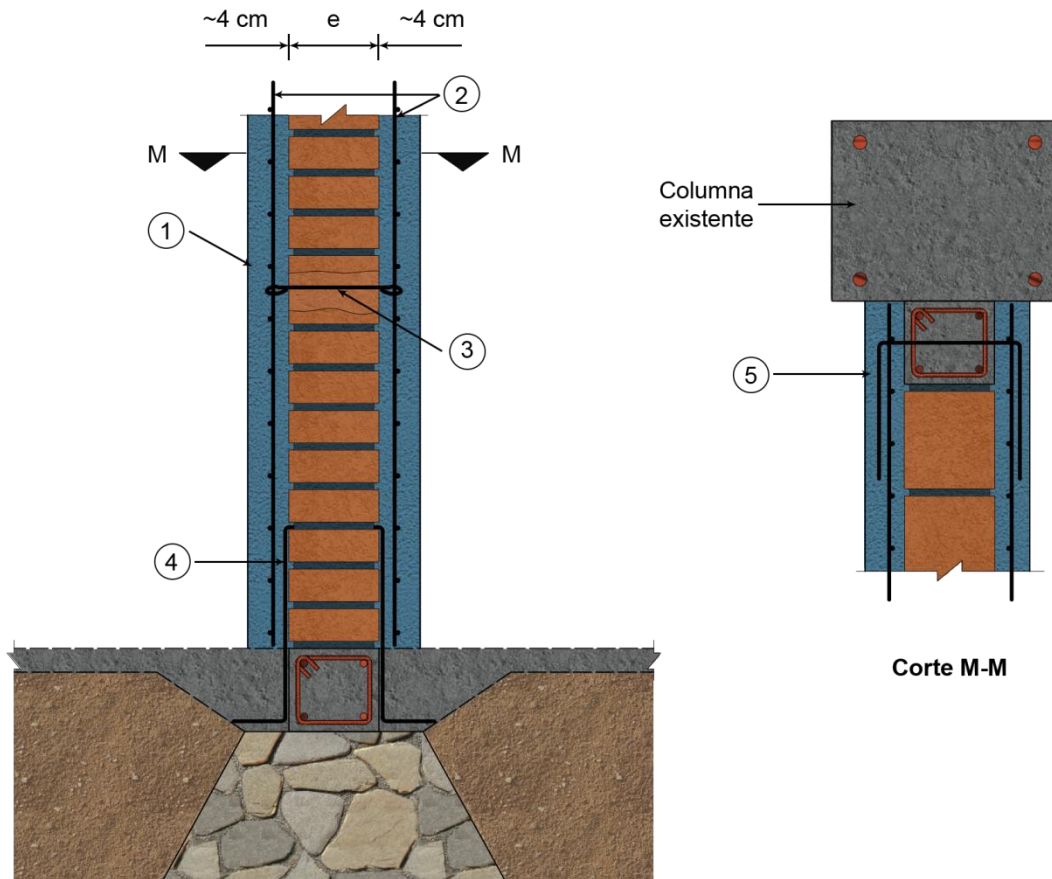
Detalles para la colocación de malla de alambre soldado sobre muros de mampostería.
